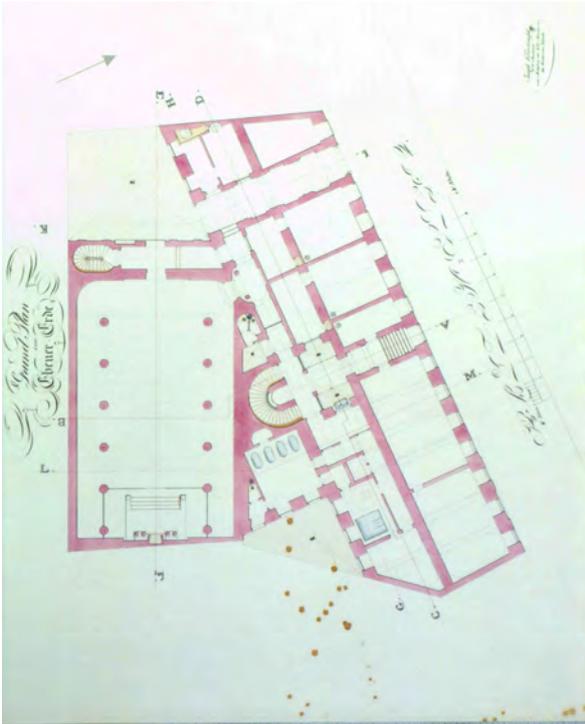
Wiener Stadttempel, Planserie "a / U 4", Grundriss, Joseph Kornhäusel, 1823
